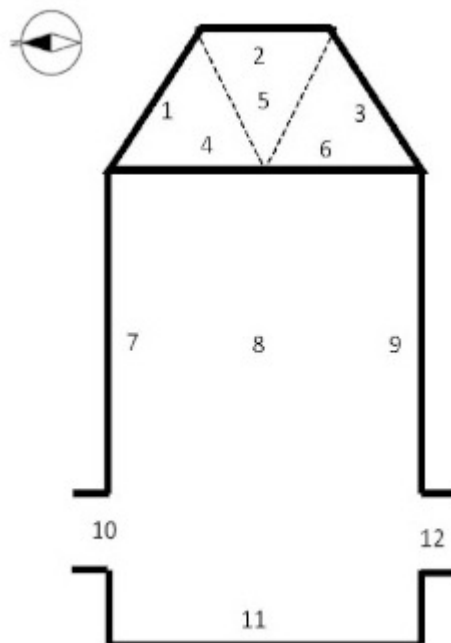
Plan de la chapelle basse : -1. la Crucifixion, mur nord-est du chœur, -2. *Noli me tangere*, mur est du chœur, -3. l'Annonciation, mur sud-est du chœur, -4. un Ballet d'anges pleu-
